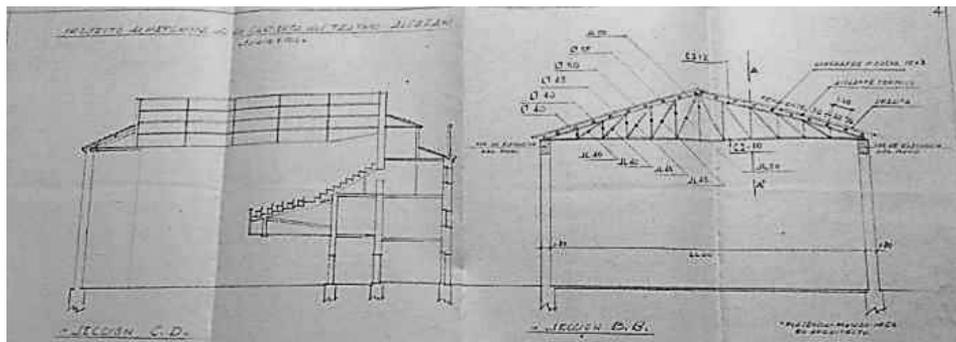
Plano de secciones. (PELLÓN Y VIERNA, J.M., 1956).
